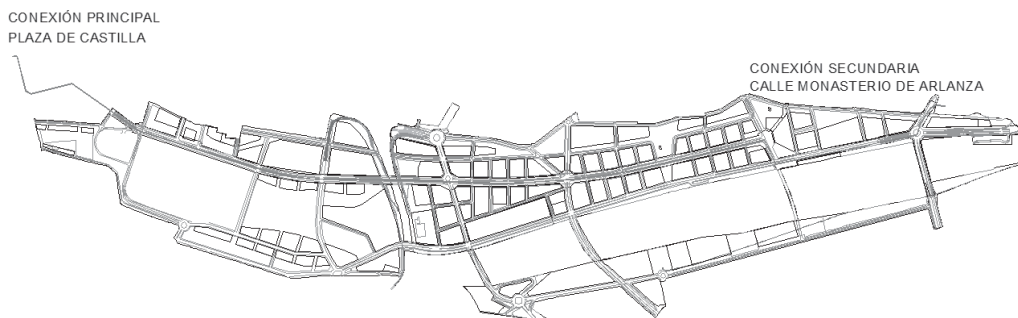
Trazado de la tubería de aducción FD 800 mm.
